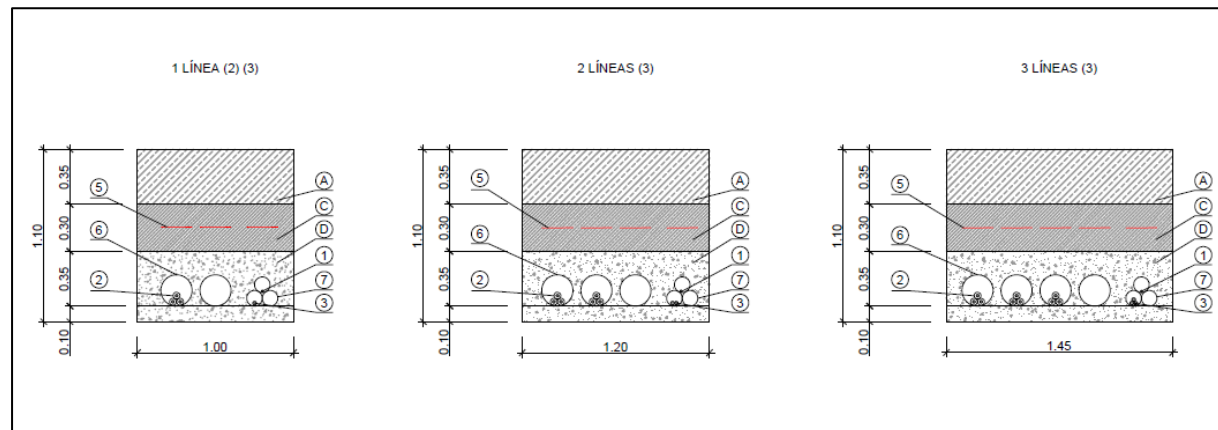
Detalle Sección Canalización. Tipo cruce vial
